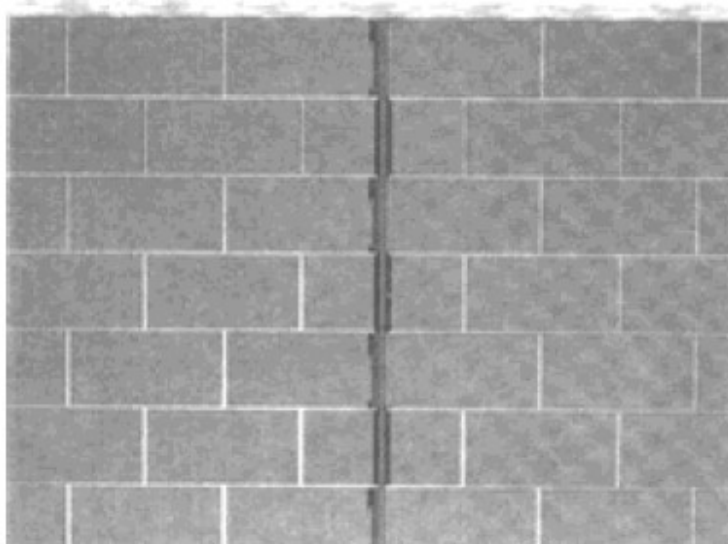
Muro de rechazo por estar “picado” para introducir tubería.
